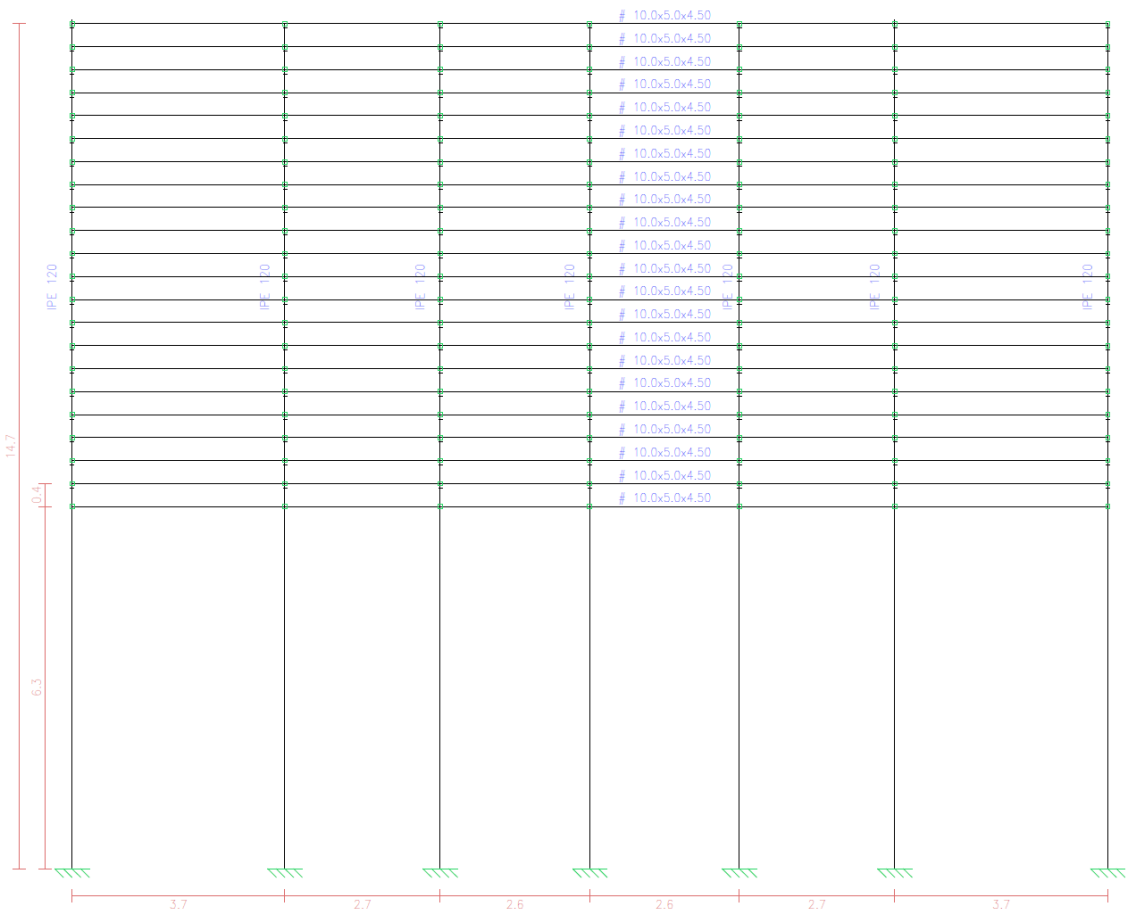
Estructura metálica portante con cotas y descripción de los perfiles
